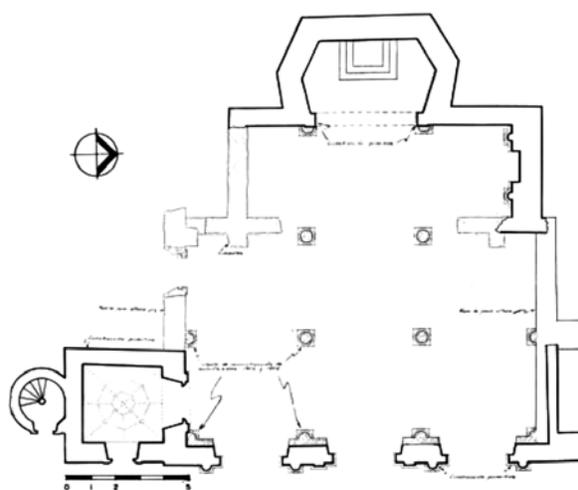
Planta arquitectónica del estado ruinoso en que se encontraba la capilla de Santa Cruz de las Flores. Dibujo: Juan Benito Artigas.
